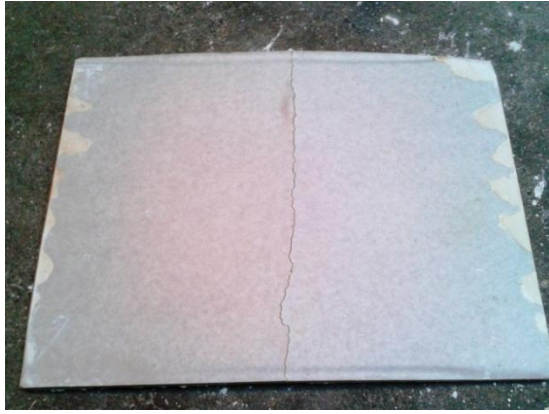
Fissura em placa de gesso e bambu após ensaio
